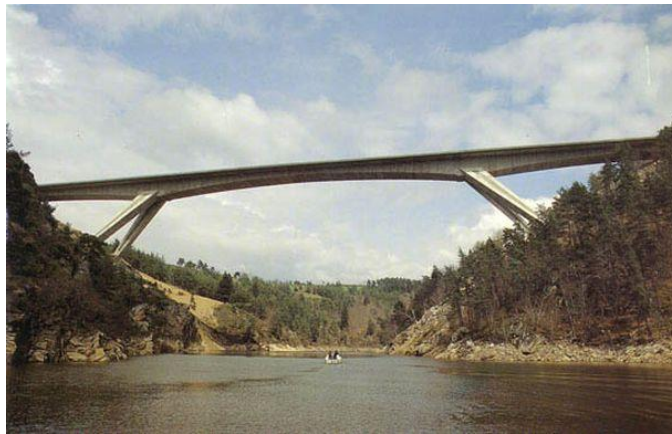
Strut Frame salvando un río. “Truyere Bridge” (Loubaresse, France)
